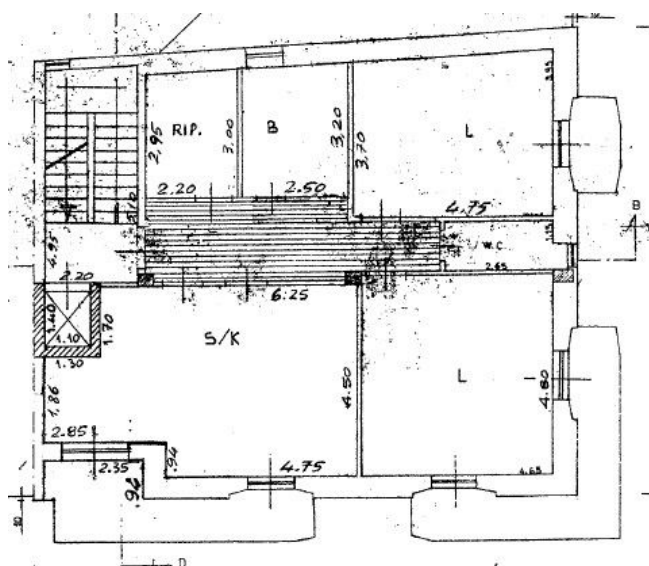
Planimetria allegata alla C.E. n. 390/2002
